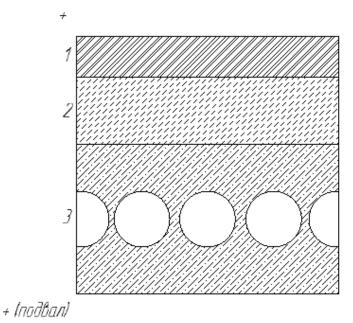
Схема конструкции подвального перекрытия: 1 – стяжка, 2 – керамзит с армированной сеткой, 3 – плита перекрытия
